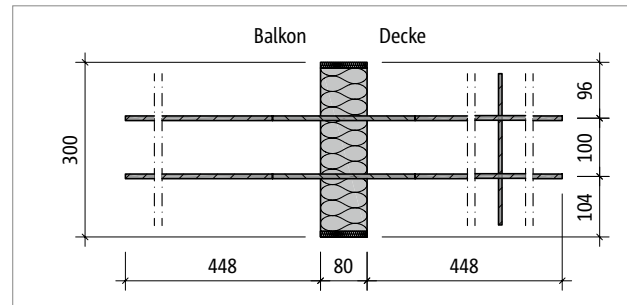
Schöck Isokorb® T Typ QP-Z-V1: Produktgrundriss
